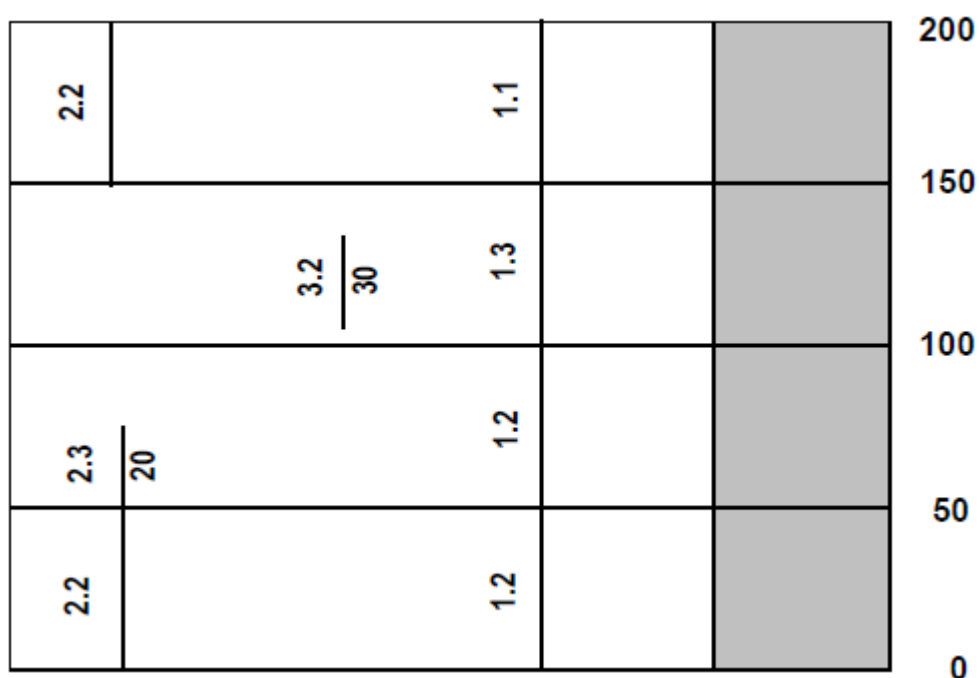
Exemplo de cálculo do IQ (Picado-Santos, 2013)
